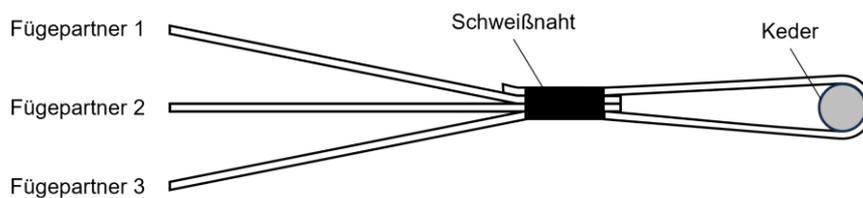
Detail einer ETFE-Randschweißnaht eines dreilagigen Kissens mit Umschlag
